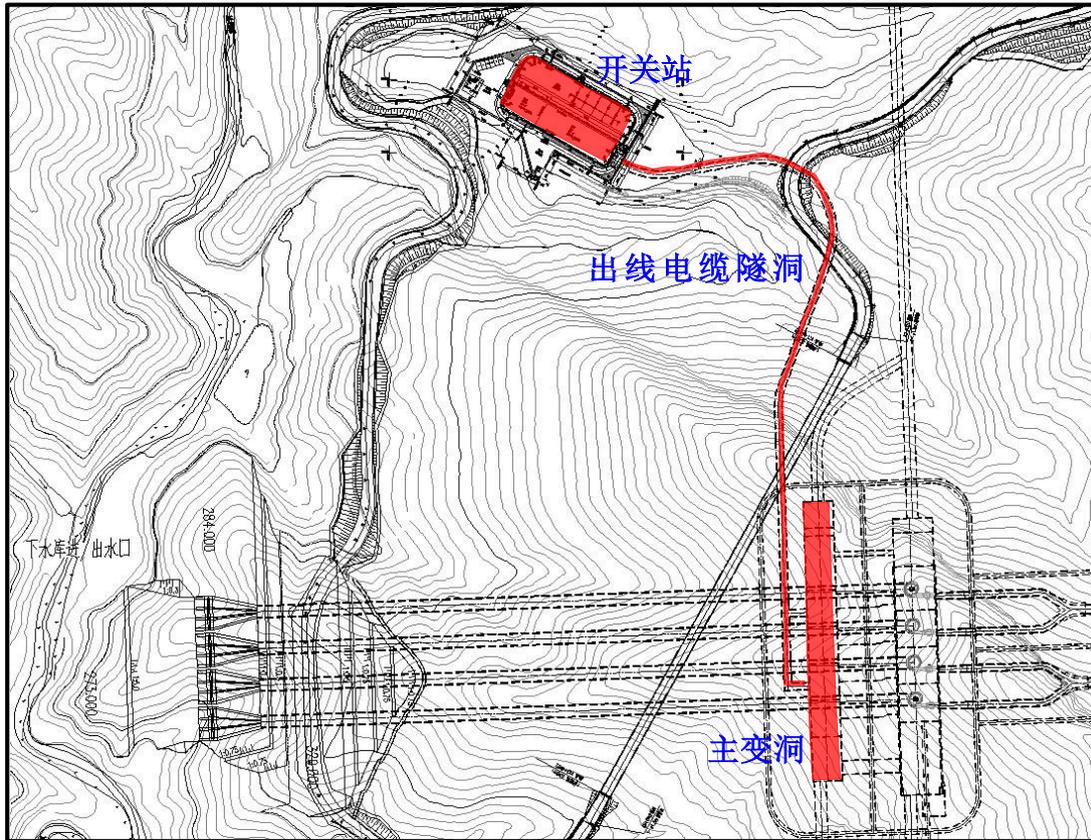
主变洞、出线电缆隧洞、地面开关站平面图
